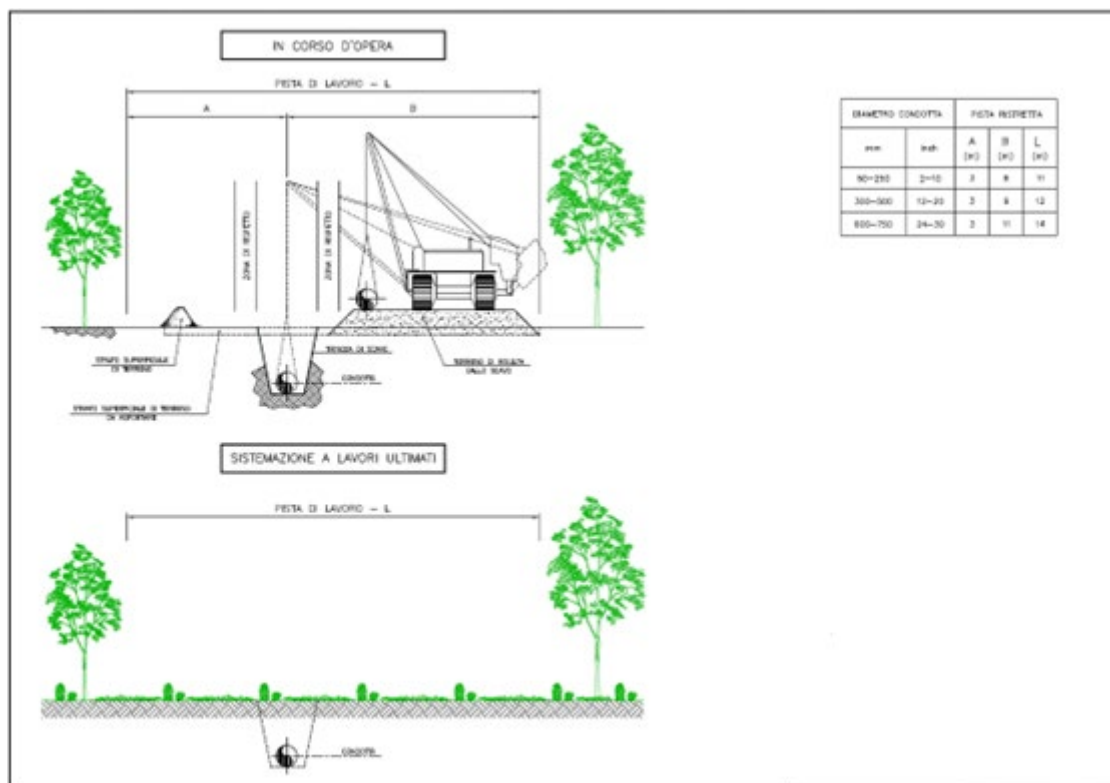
Sezione Tipica Pista di lavoro “Ristretta”
